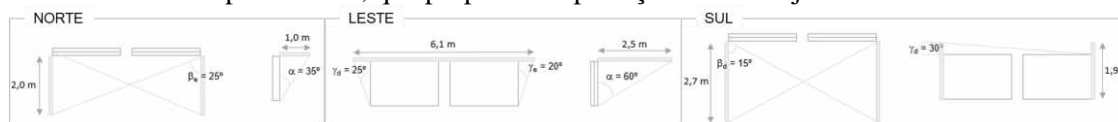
Dimensionamento de brises de projeto para fachadas Norte, Sul e Leste (OS AUTORES).
